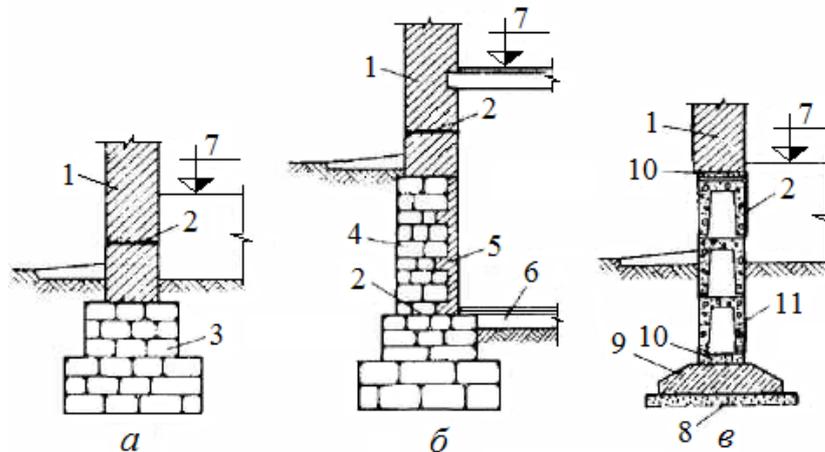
Конструкции ленточных фундаментов: а – бутовый фундамент с уступами; б – бутовый фундамент здания с подвалом; в – сборный фундамент многоэтажного здания; 1 – стена надземной части здания; 2 – гидроизоляция; 3 – монолитный фундамент; 4 – фундаментная стена; 5 – кирпичная облицовка; 6 – пол подвала; 7 – уровень пола первого этажа; 8 – слой песка или щебня толщиной 50 – 100 мм; 9 – фундаментная блок-подушка; 10 – армированный пояс; 11 – фундаментный стеновой блок
